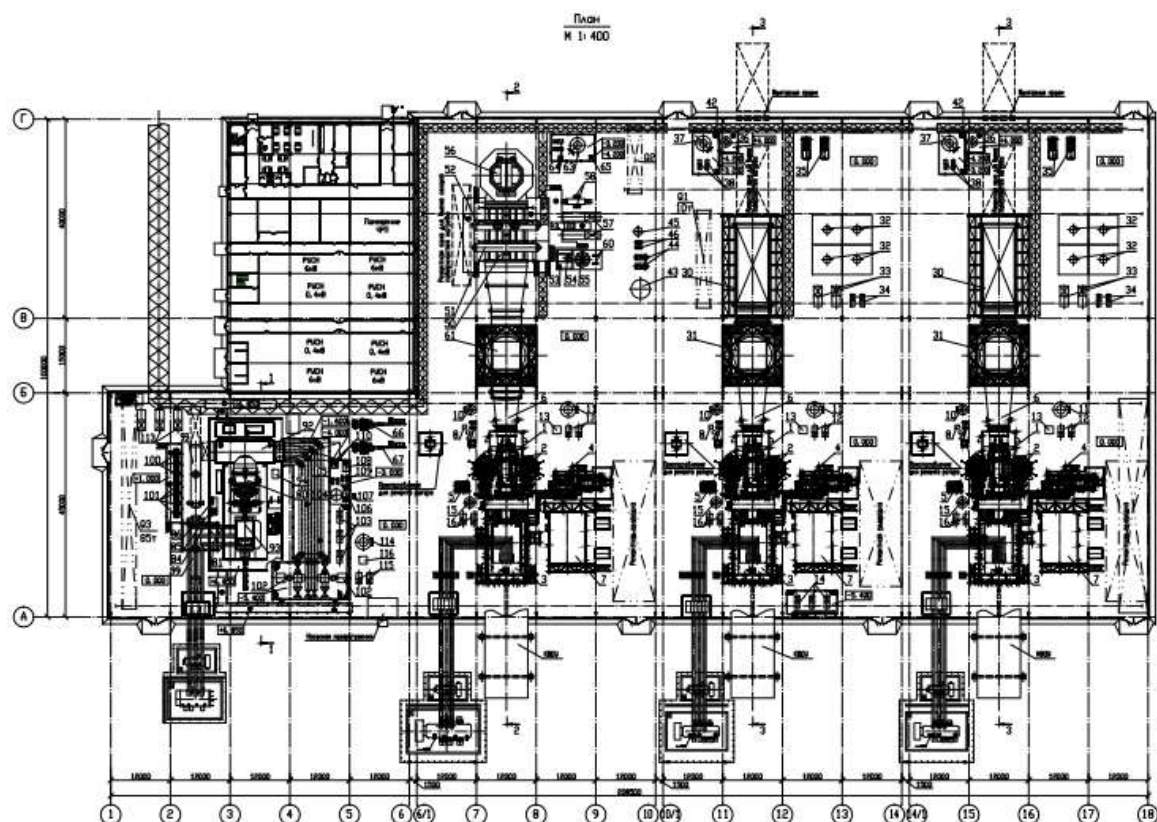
В.4.2. Компоновка главного корпуса ГТ-ТЭЦ
